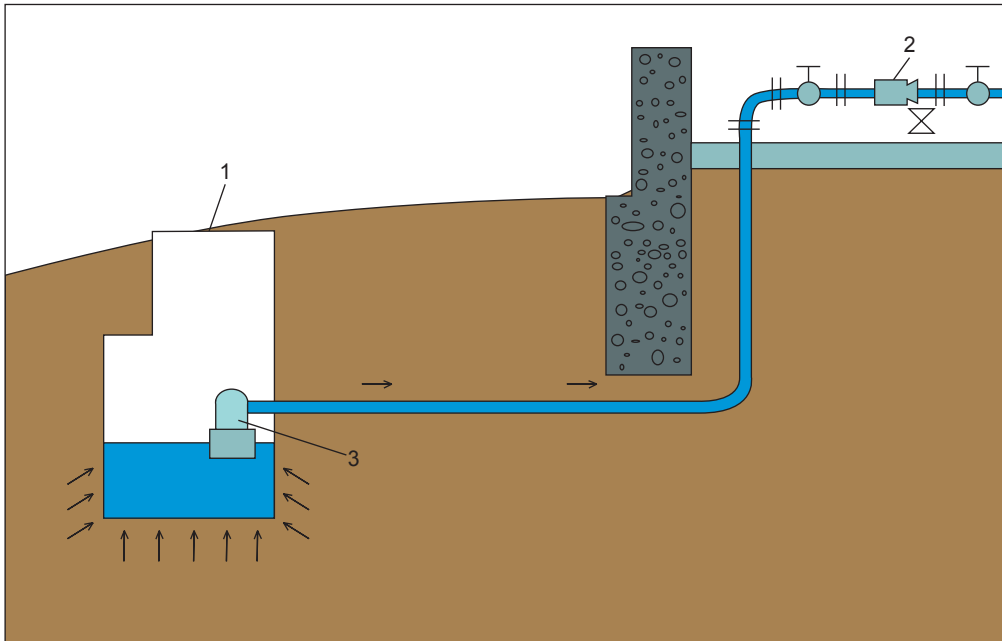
Схема прокладки водопровода под фундаментом: 1 — каптажная камера; 2 — водомер; 3 — насос
